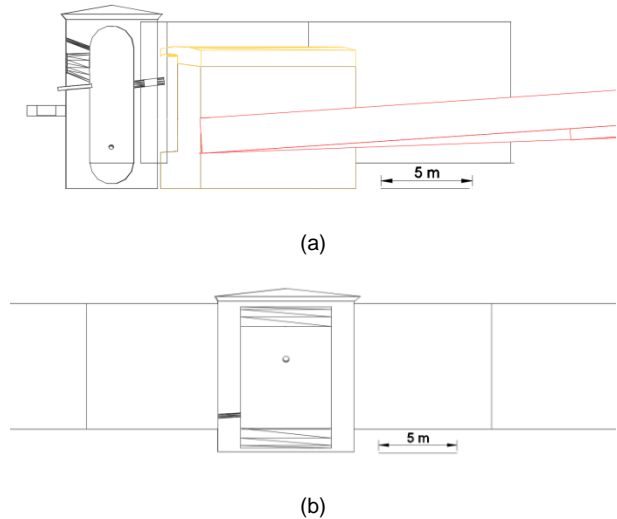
Cortes del sistema de captación de aguas según las trazas de los planos seccionantes del plano de Sánchez-Molero: a) Corte AB; b) Corte CD.
